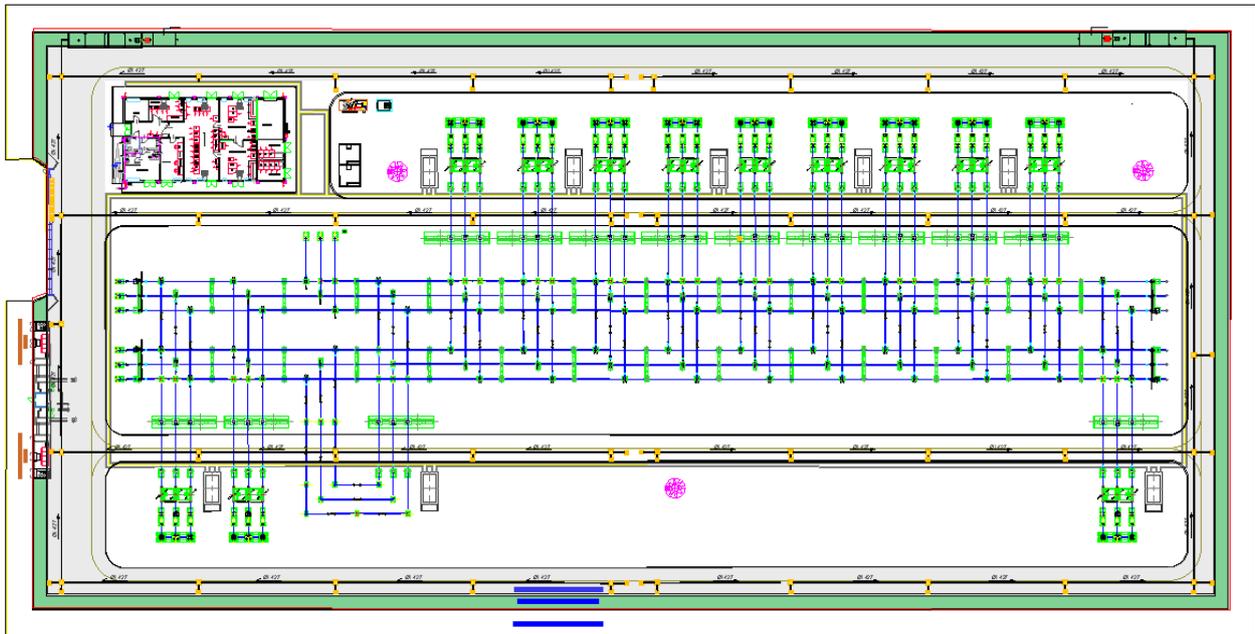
6 Planimetria raccolta e trattamento acque meteoriche di dilavamento stazione elettrica
